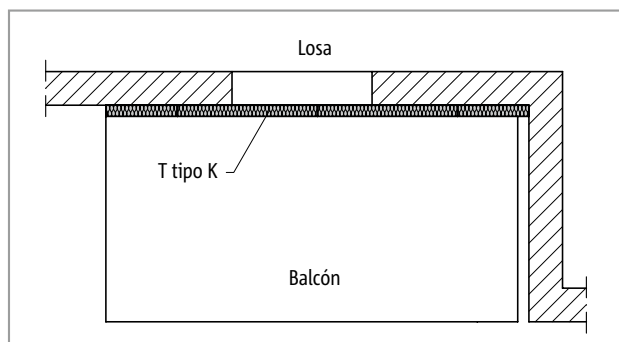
Schöck Isokorb® T tipo K: Balcón en fachada saliente
